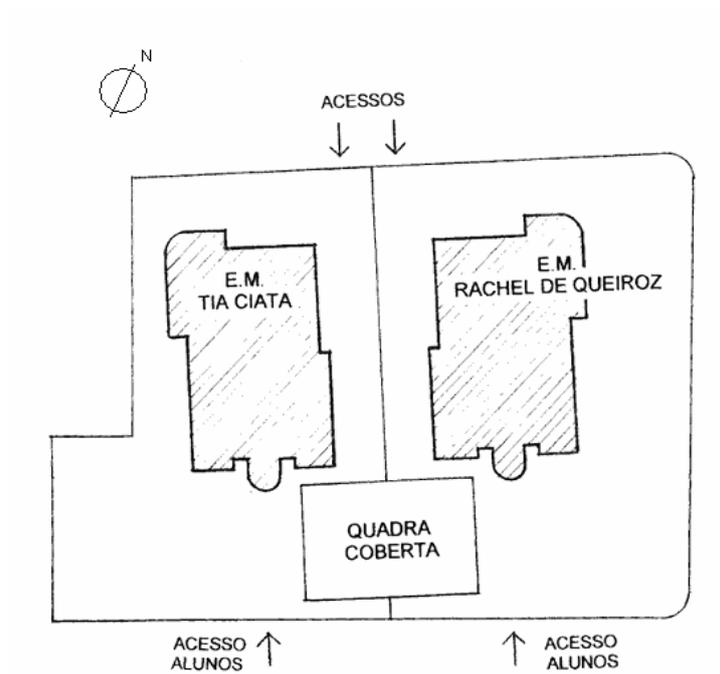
E.M. Tia Ciata - Planta de Situação Esquemática
